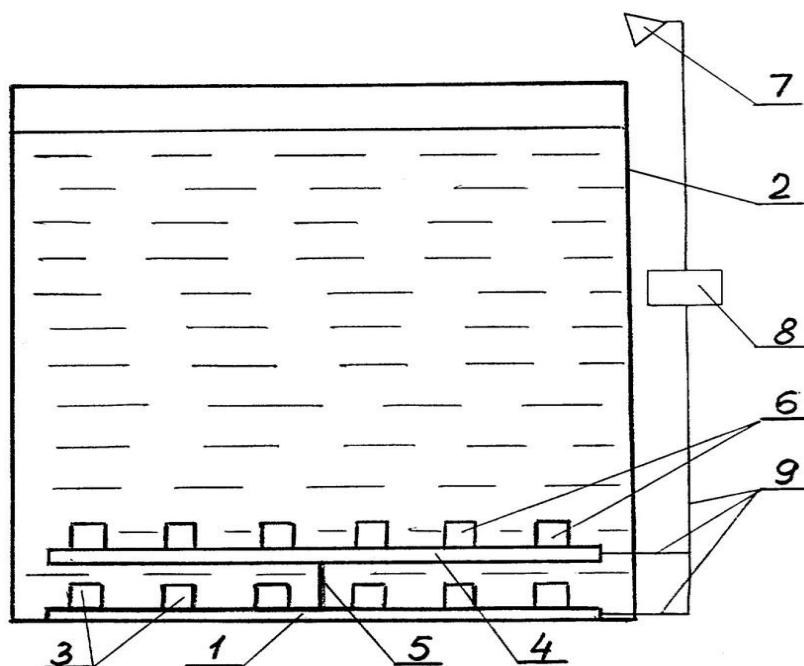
Устройство противопожарной защиты резервуаров
